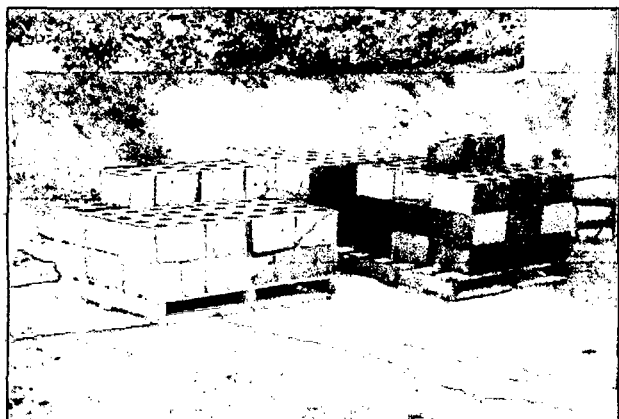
= Almacenamiento y transporte de unidades de concreto celular en planta
